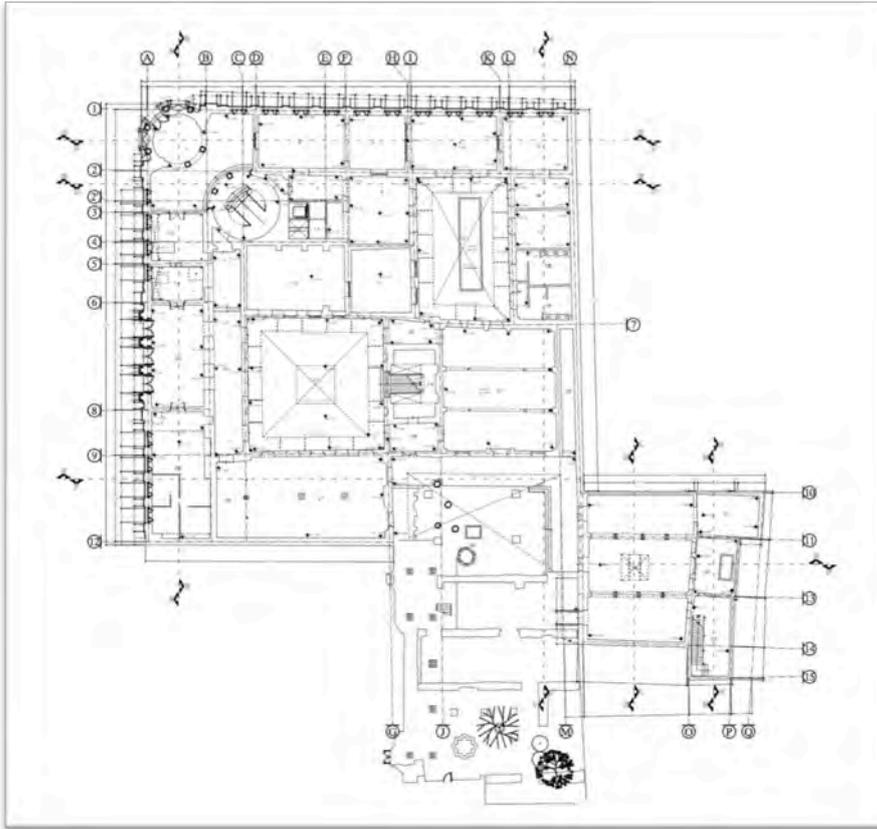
Planta Baja de estado actual. Planos hechos por el Instituto de Ingeniería.
